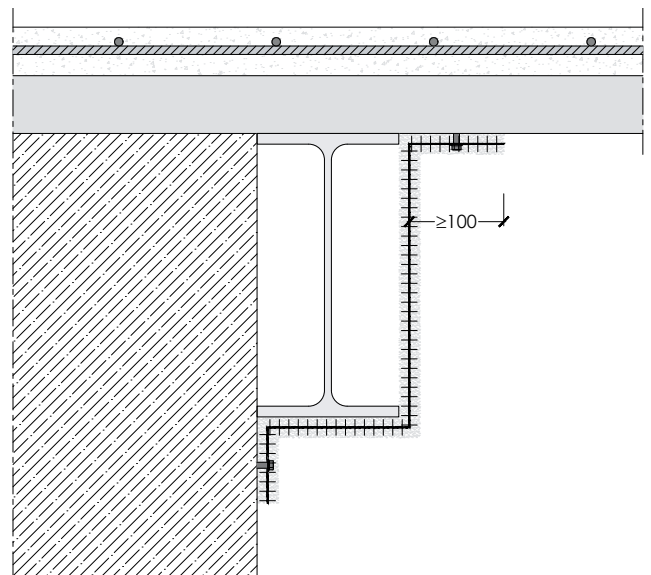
Schema di applicazione per protezione di trave di bordo in carpenteria metallica, posizionata in corrispondenza di muratura resistente al fuoco. (applicazione a box)
